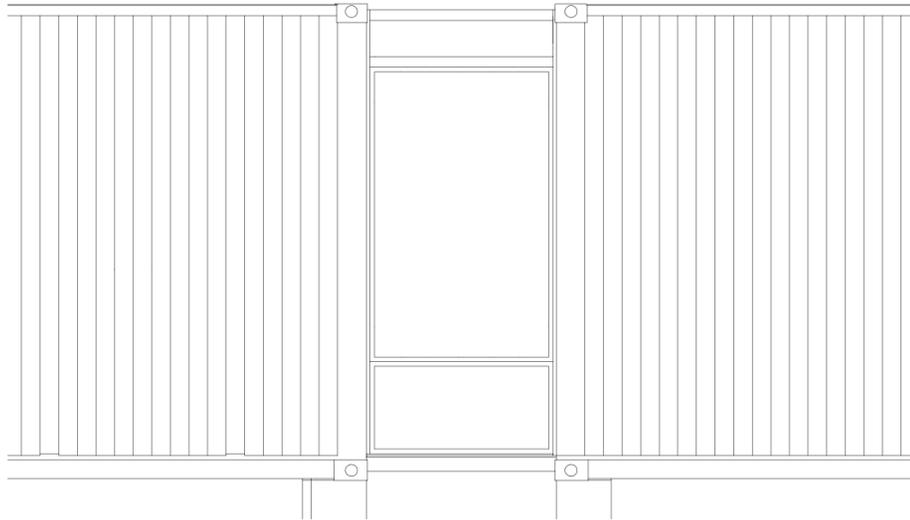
Vista en Conjunto de Tubo Estructural con Angulo de 3x2"
